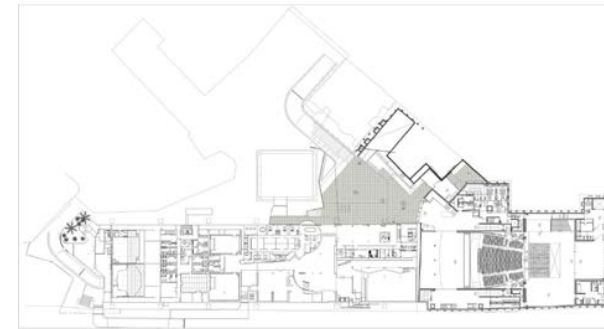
Planimetría del Centro Cultural Gabriela Mistral
